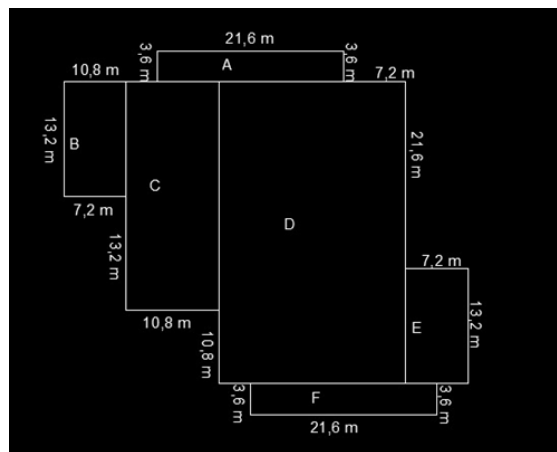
Pemodelan Rencana Bangunan di Aplikasi Tekla
